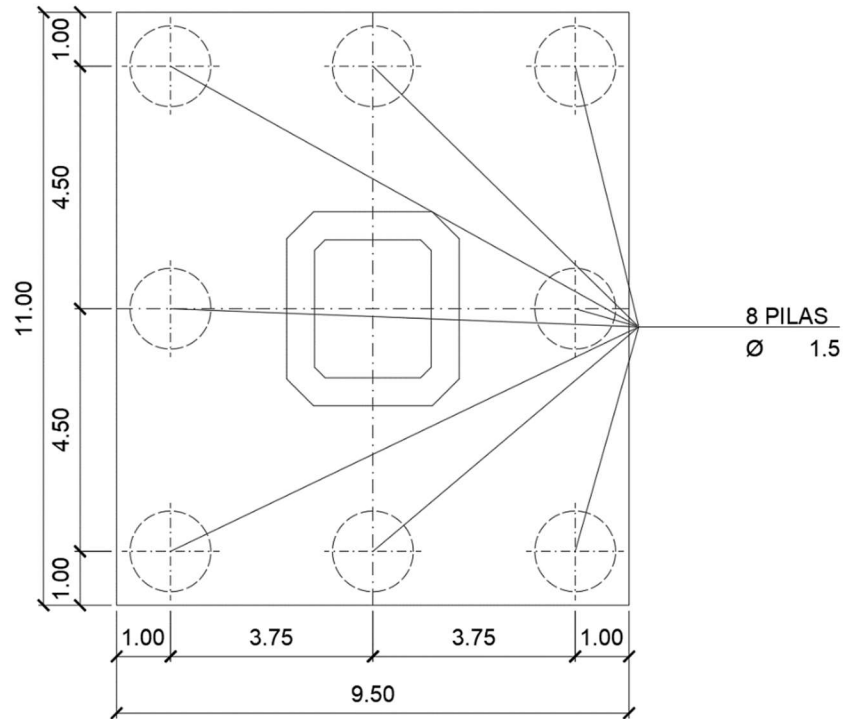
Vista en planta de la zapata con la proyección de la columna y de las pilas
